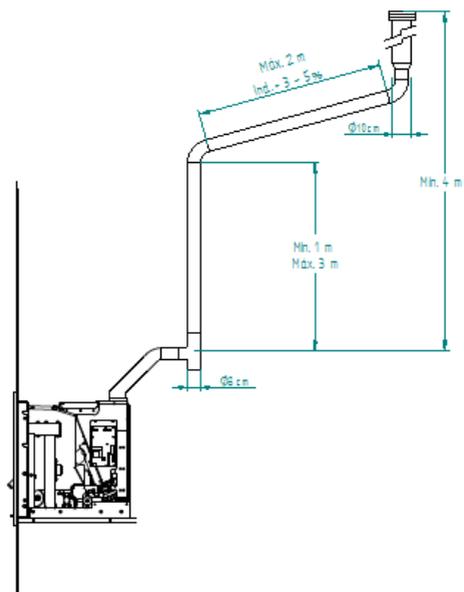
Exemple d'un conduit extérieur avec T tampon
